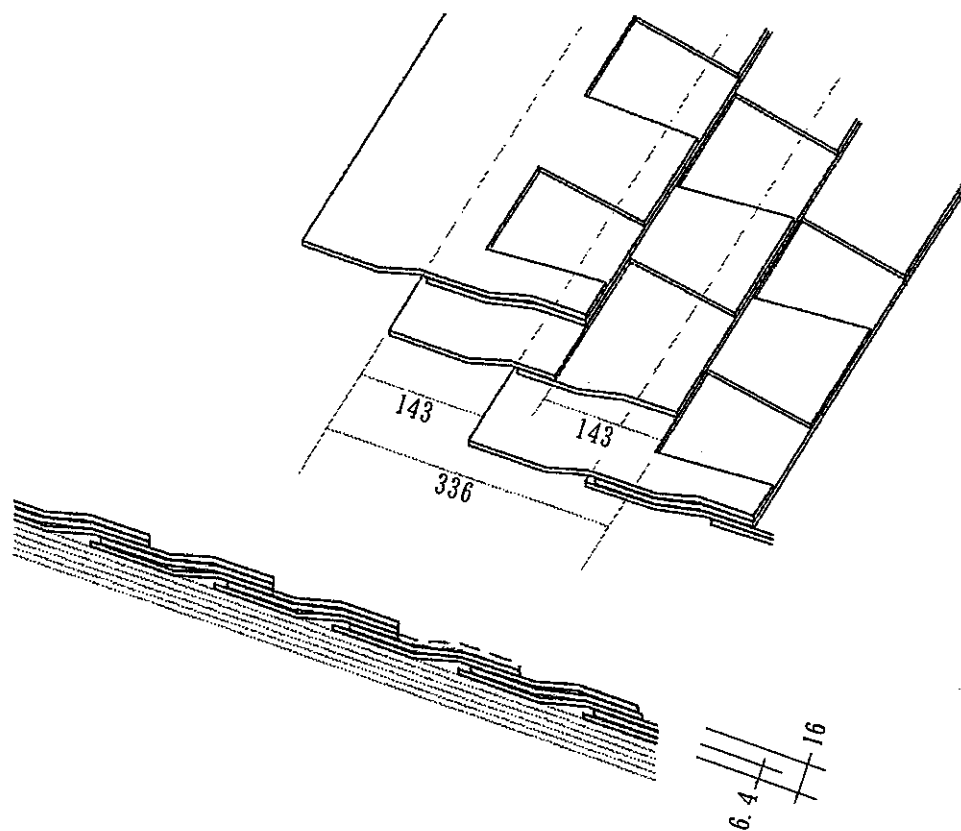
申請仕様の施工図 (アスファルトシングルの施工: コンポジットタイプ)
